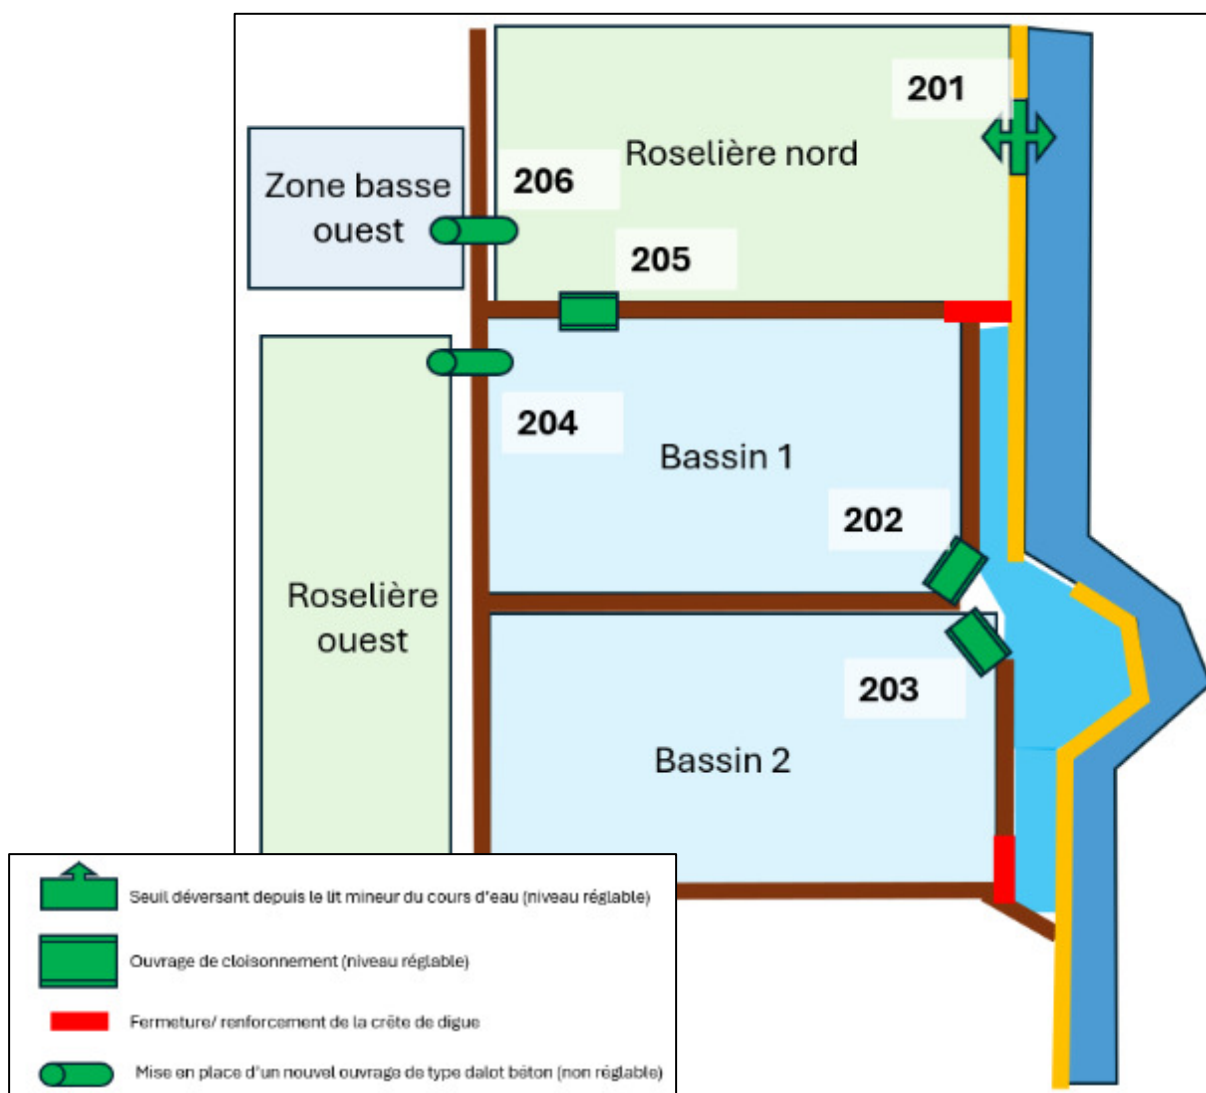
Schéma de principe d'implantation des ouvrages hydrauliques
